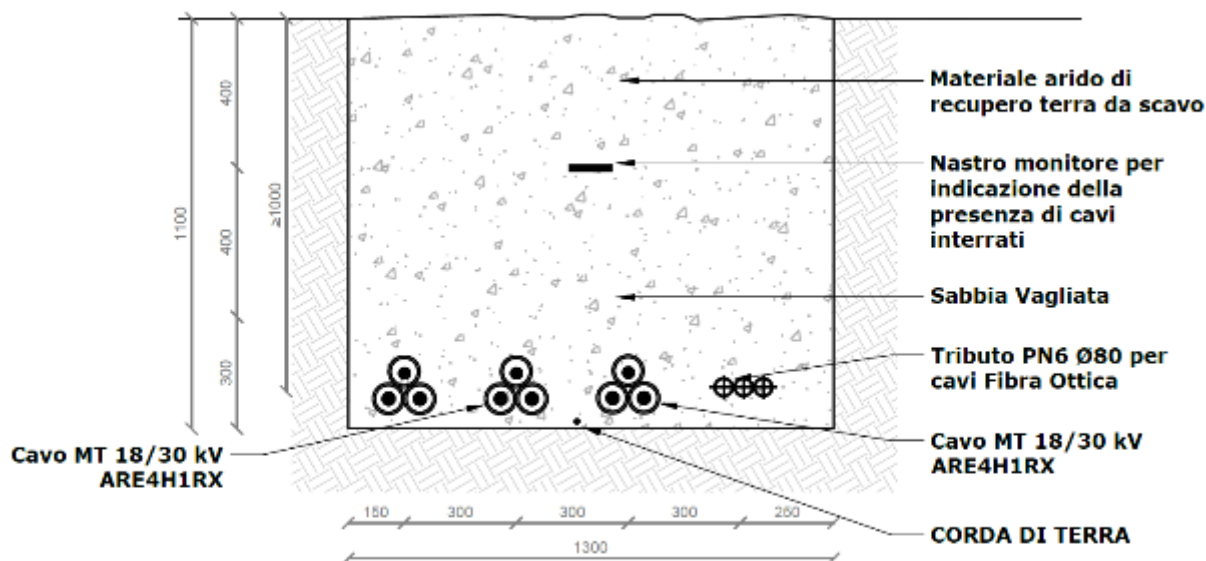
Sezione tipo posa cavidotti 30 kV su campo/strada sterrata
